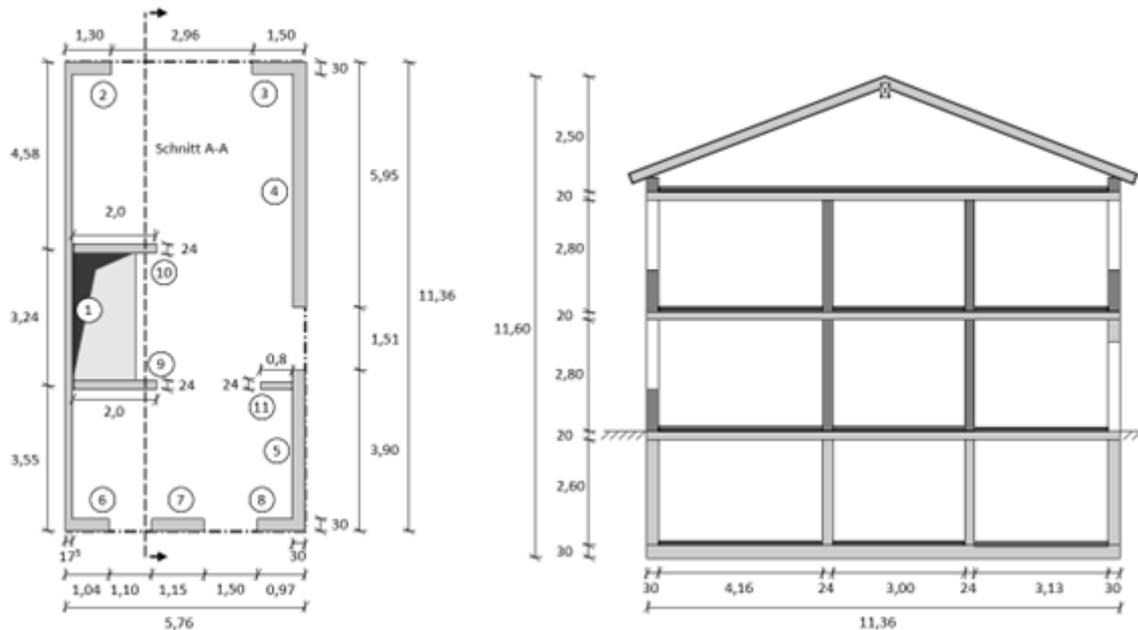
Grundriss und Ansicht des betrachteten Reihenhauses
